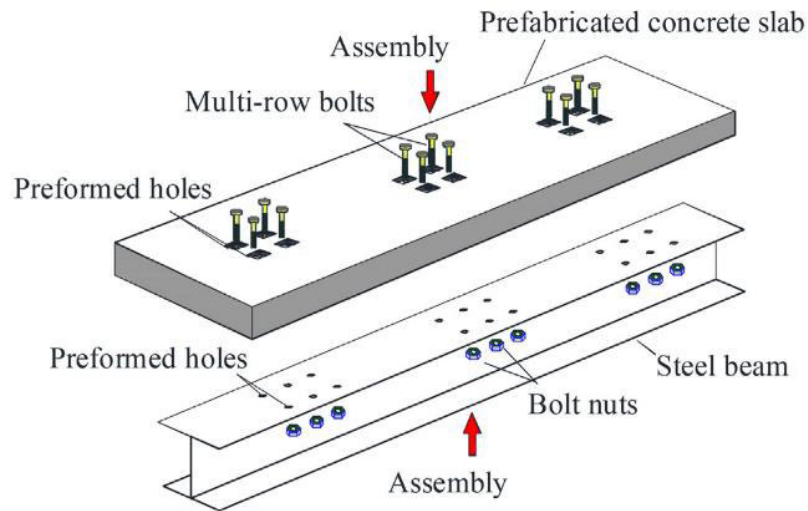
Viga compuesta hormigón-acerio con conectores de corte múltiples
